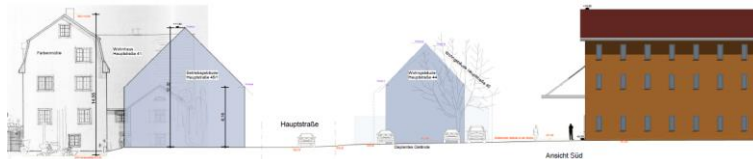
Querschnitt Hauptstraße – Mühlengebäude - Haus Nr.44 - Versandgebäude
